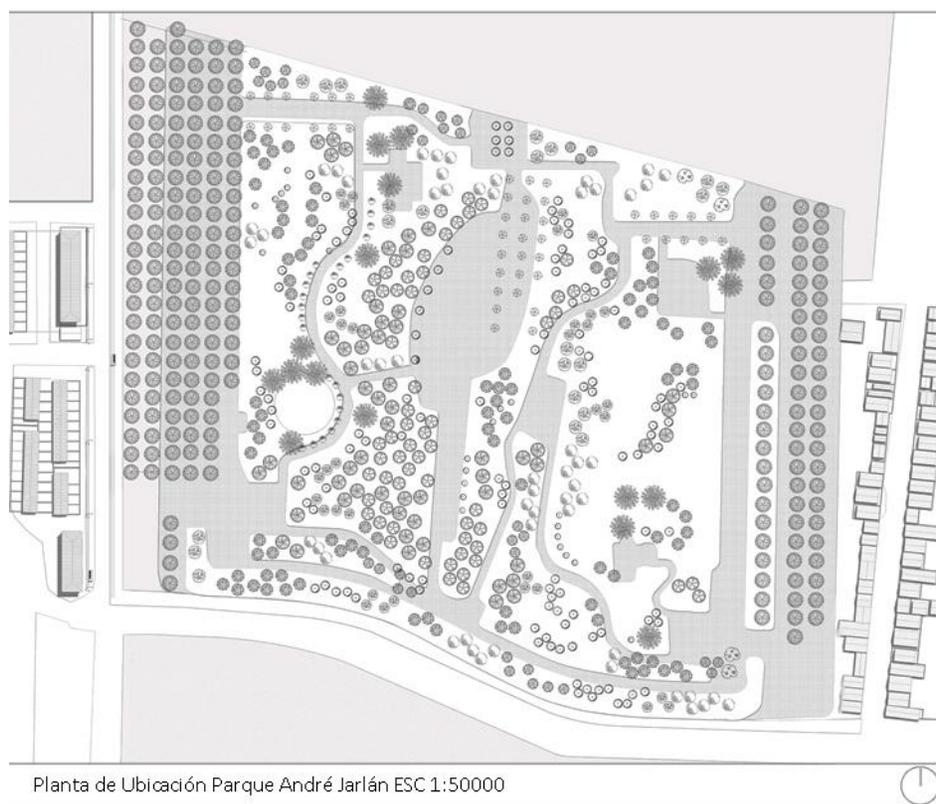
Planta de Ubicación Parque André Jarlán, Pedro Aguirre Cerda, R. Metropolitana.
